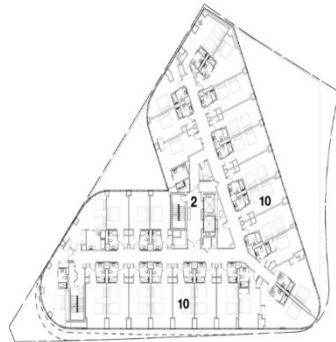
Plan des étages intermédiaires de l'hôtel Hilton Garden.
